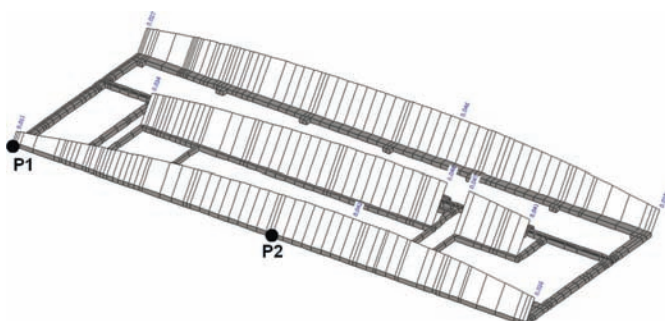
Эпюры расчётного подъёма фундаментов здания при морозном пучении
